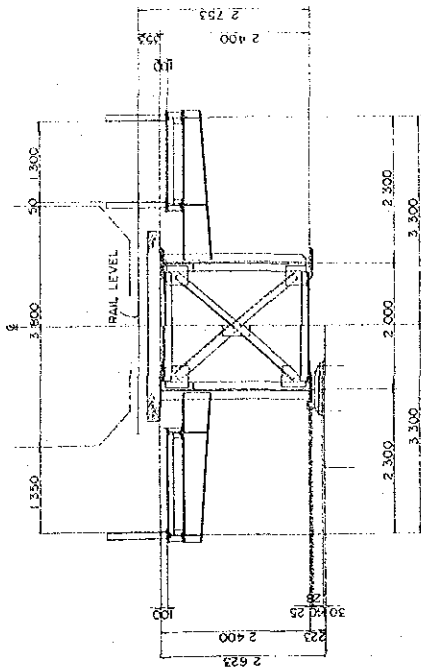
PILIER ET BUTEE DU PONT SUR LA RIVIERE NDJILI
